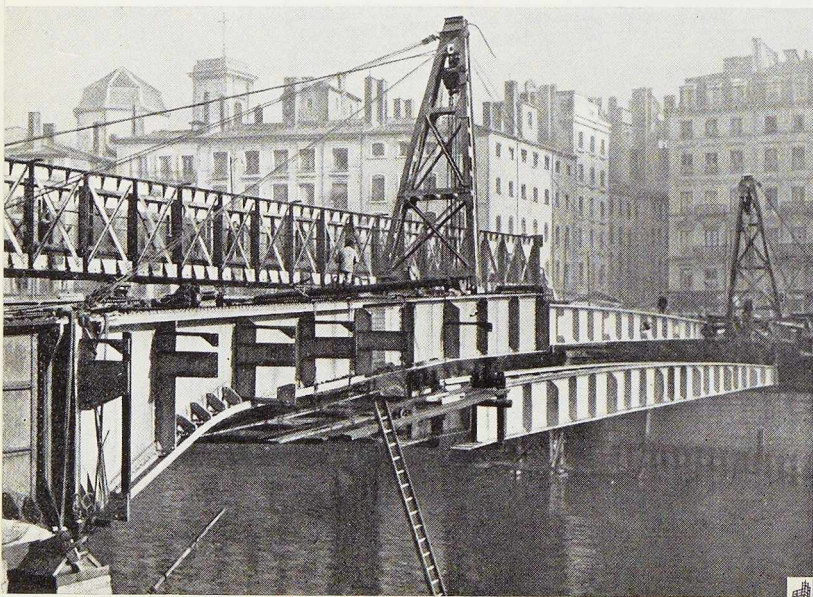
Levage, à l'aide de deux chèvres, d'un couple de poutres de 39,75 m. A l'arrière-plan, le pont provisoire.
